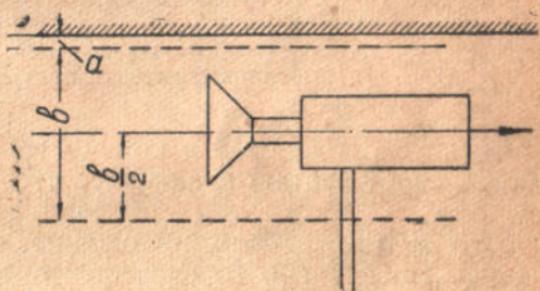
Схема установки скреперно-элеваторной машины: *a* — ширина межкарьерной бровки *b* — ширина карьера.
